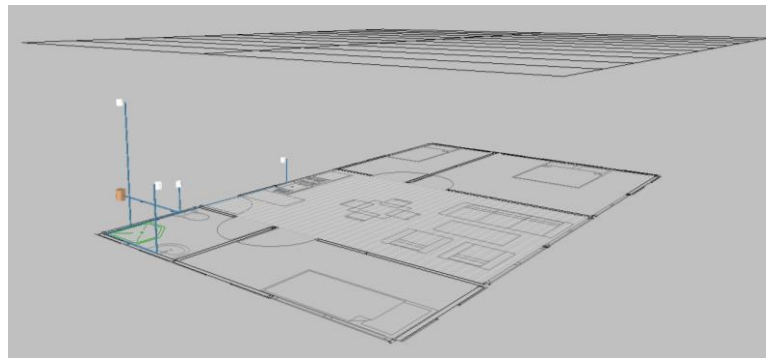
Conexión de fontanería de la vivienda de 1 planta, vista 3D
